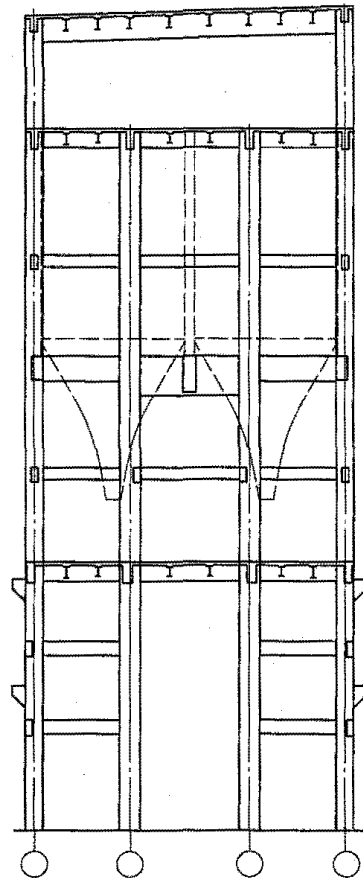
钢筋混凝土侧煤仓间典型剖面图
